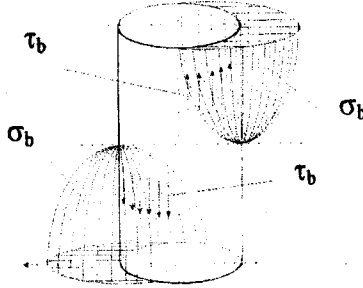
Внутрішні зусилля, що діють на бетон замоноличення стакана сталобетонного фундаменту під труобетонні колони
